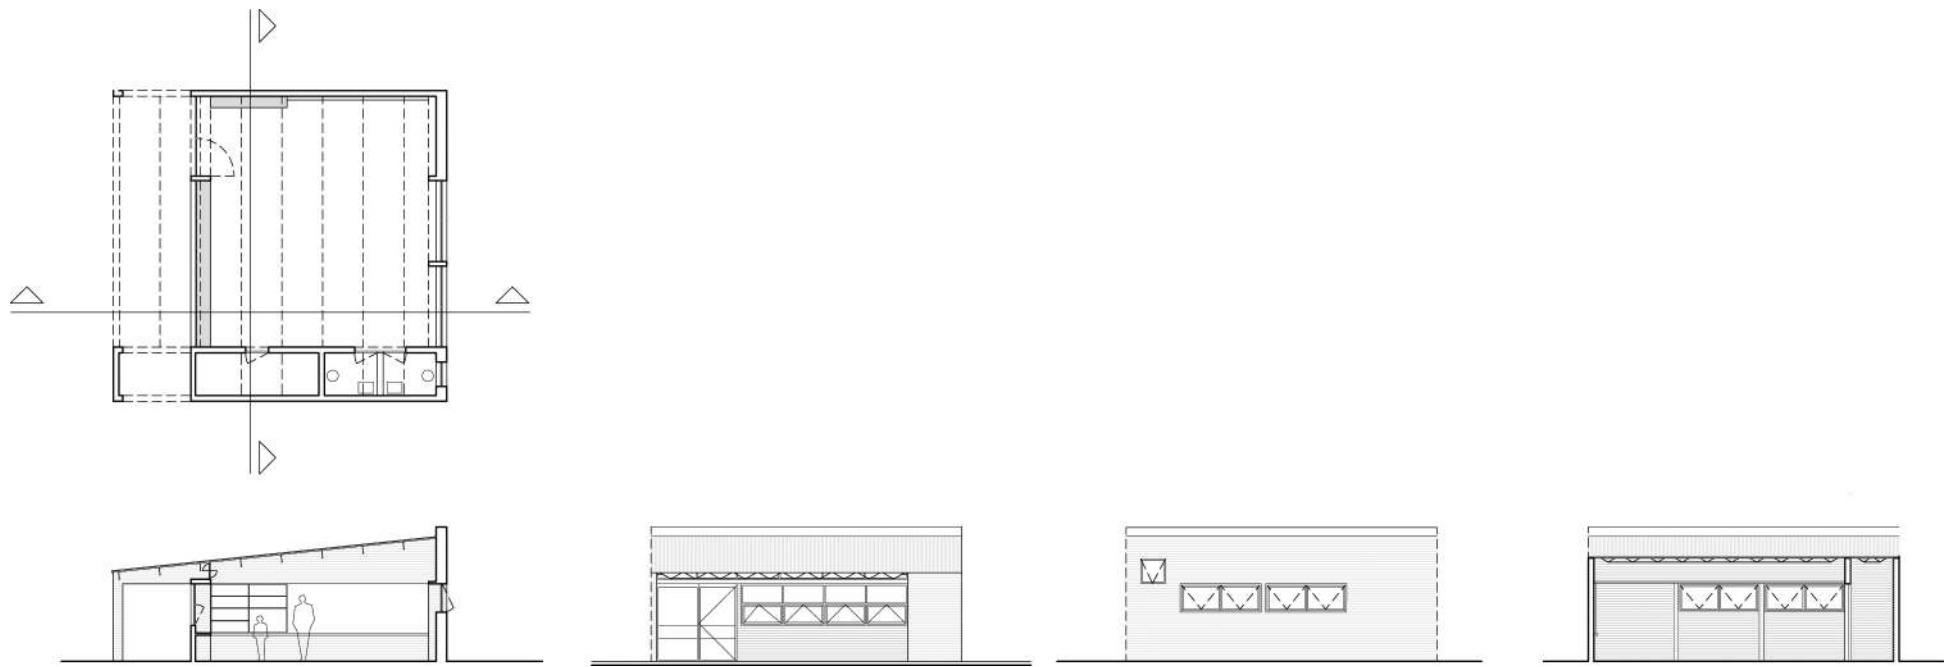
Planta, cortes y alzados Aula Integral versión D2, escala 1:200. Fuente: dibujos del autor.
